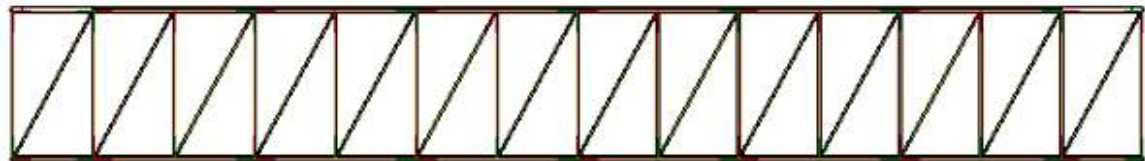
Tablero de la pasarela visto en planta. Fuente: propia.
